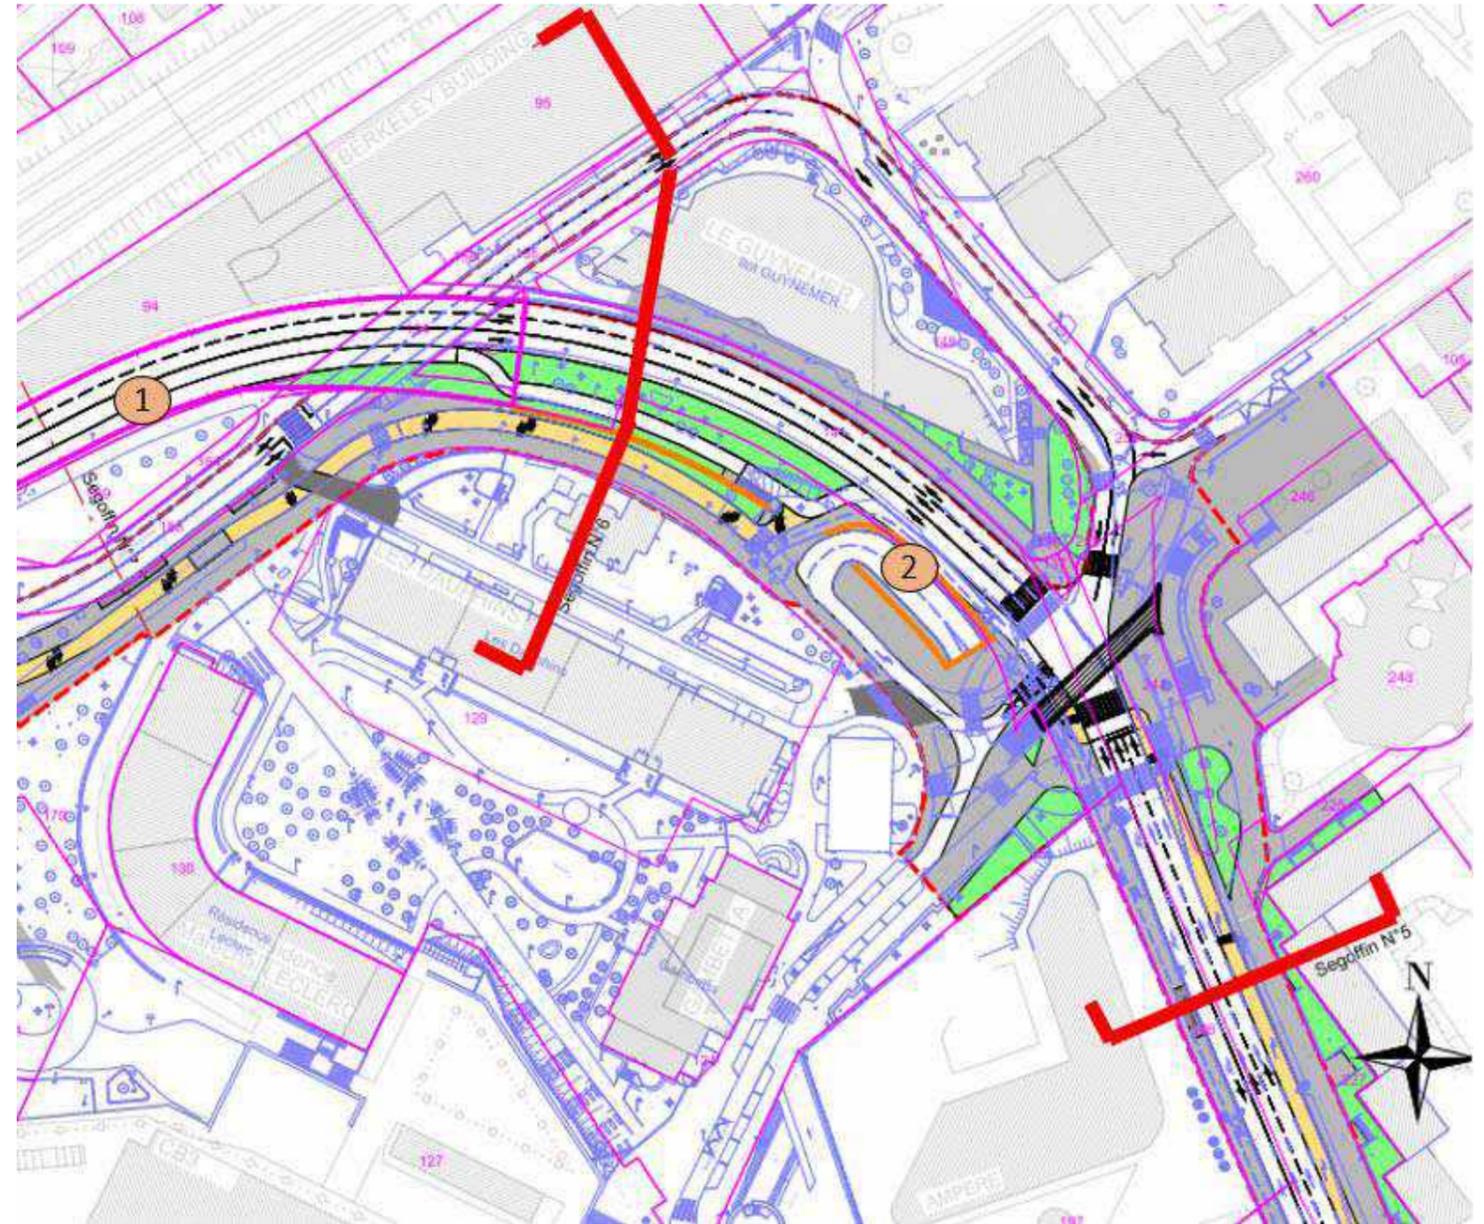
Secteur Segoffin - Scénario double sens - Vue en plan
